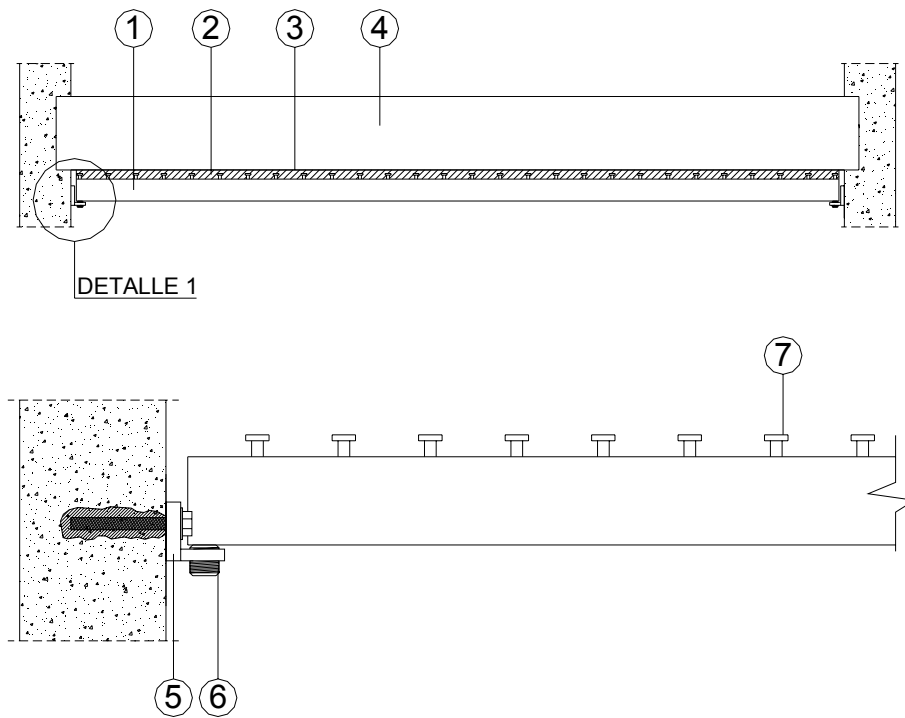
PERFIL DE REFUERZO TUBO CR
